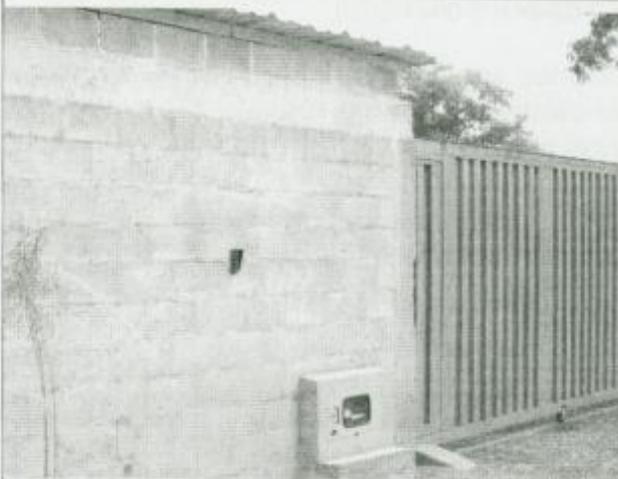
Muro de cerramiento en bloques de concreto en el predio en mención
